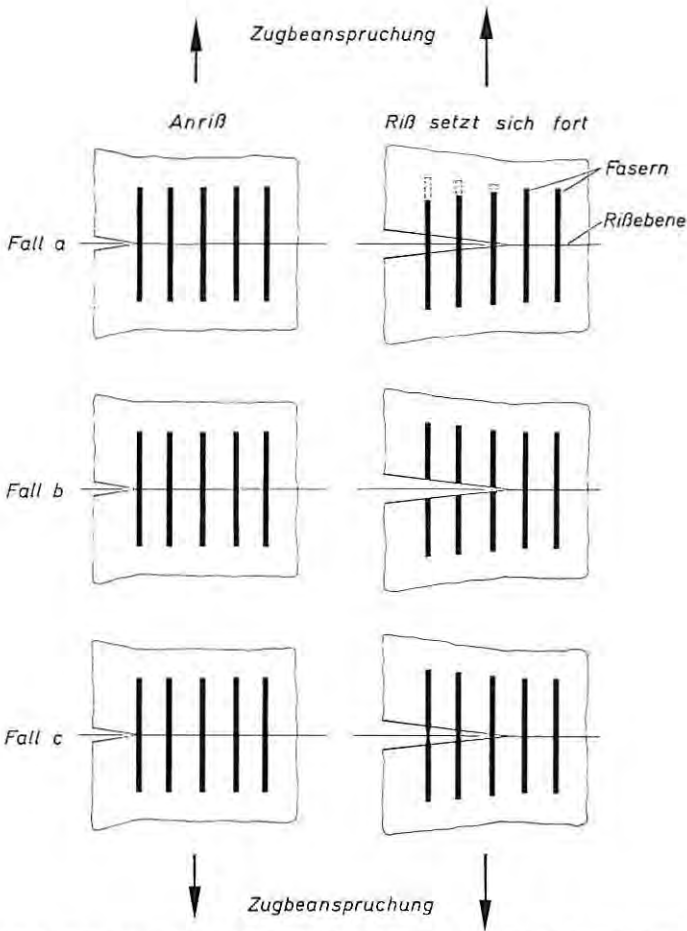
Bruchvorgänge bei mit kurzen Fasern bewehrtem Beton unter Zugbeanspruchung
